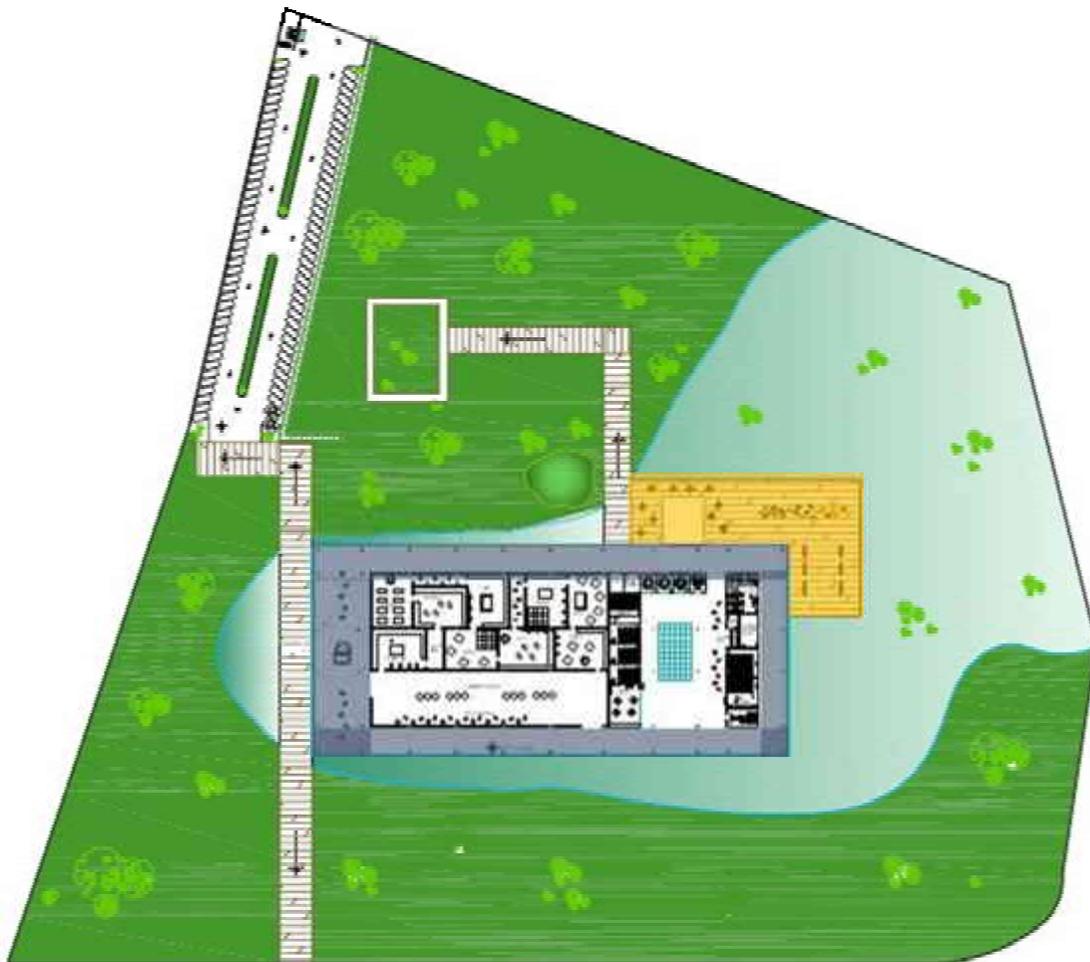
Planta arquitectónica. La cafetería y área de exposición al aire libre sirven como miradores (naranja), el pasillo perimetral (rojo) cumple con la misma función gracias a la transparencia de la fachada
